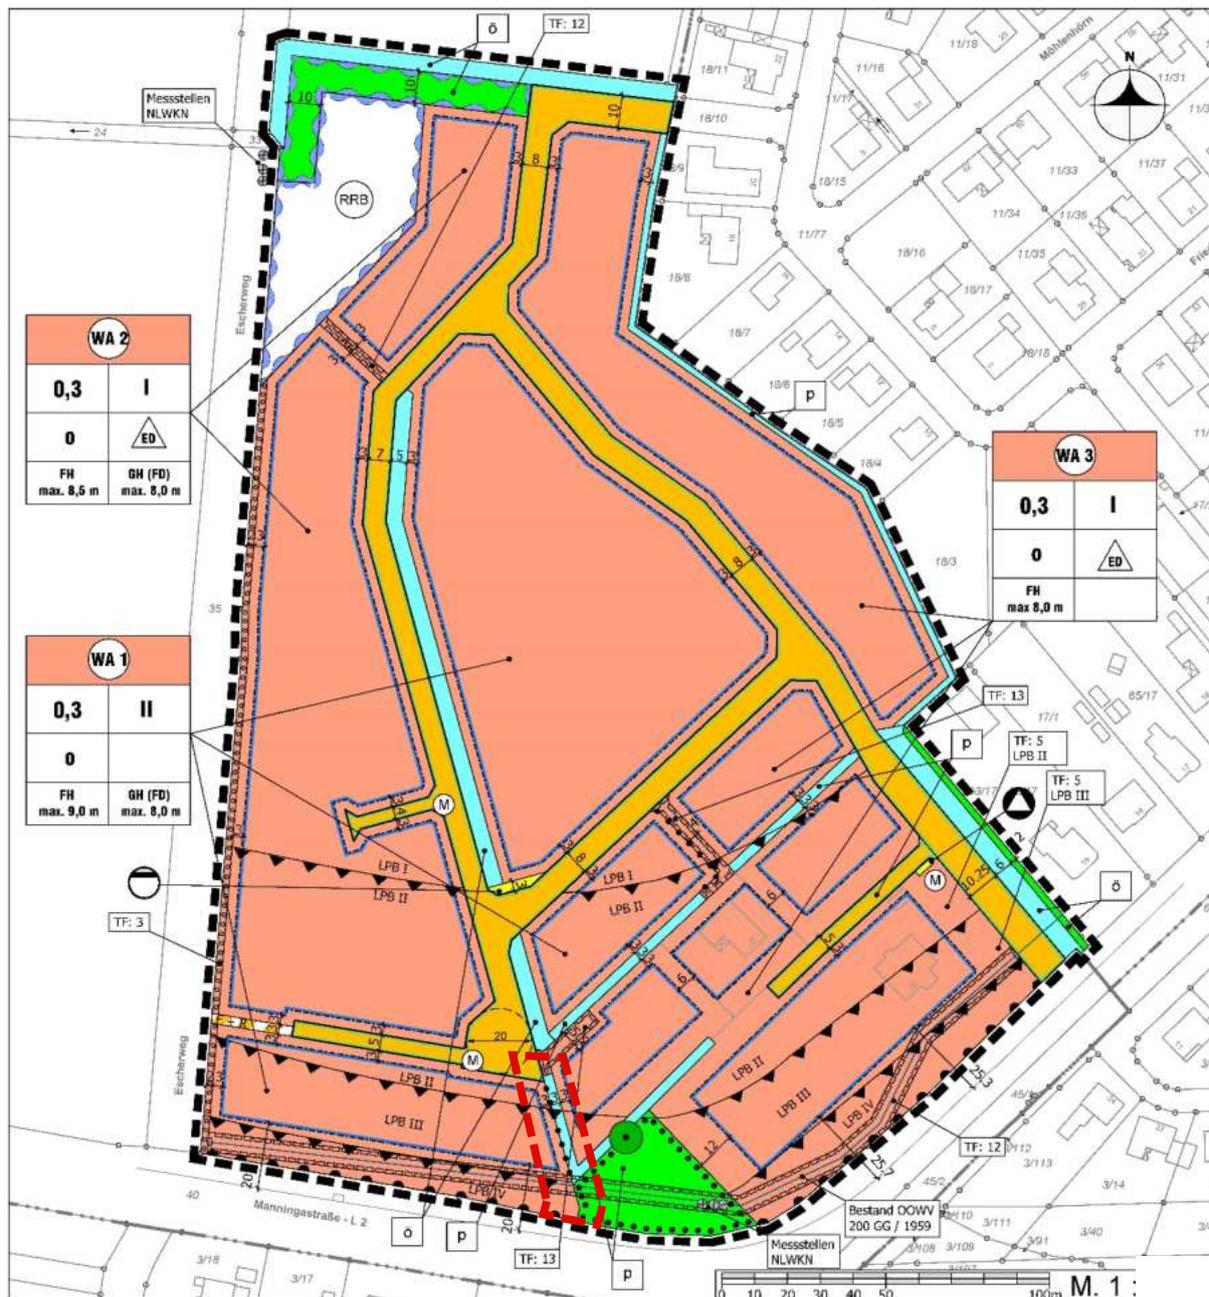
Ursprünglicher Bebauungsplan Nr. 1227 "Escherweg" mit Änderungsbereich
